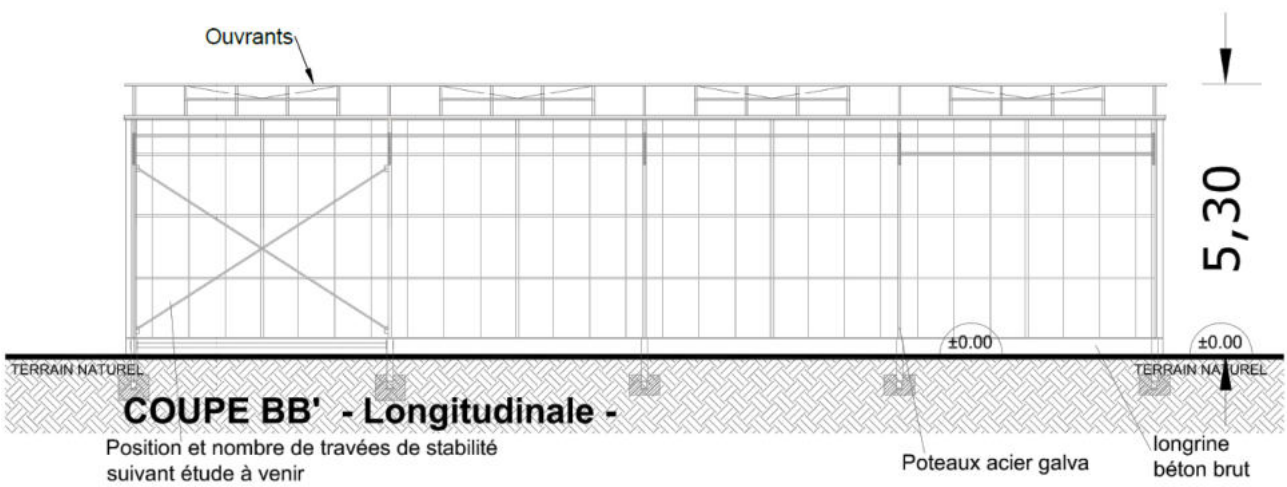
Coupe type serre multi-chapelles, côté long pan. Source : Reden.
